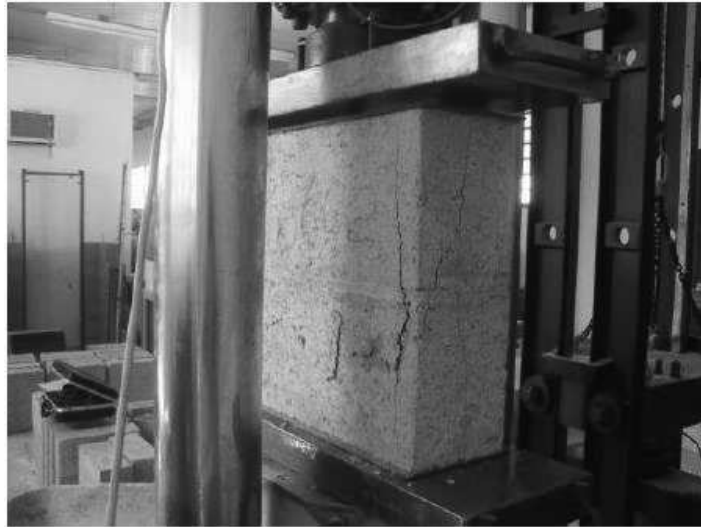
Ensaio de prisma de dois blocos de concreto.
